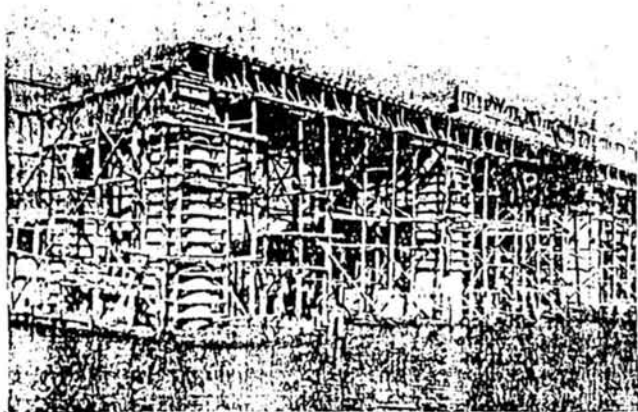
遠賀川橋、橋桁コンクリート工事の状況。<sup>21)</sup>
